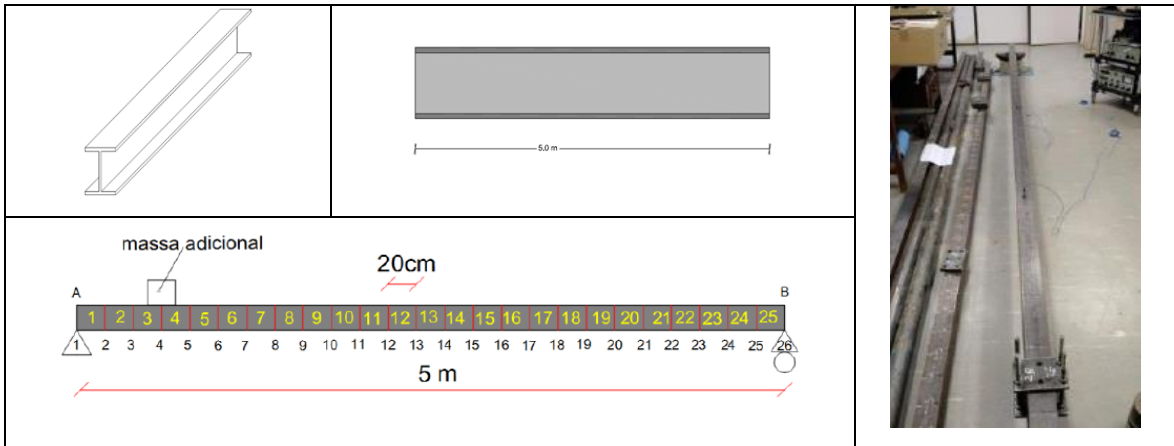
Viga Metálica Biapoiada Intacta (5 m): caso 11 (Palechor, 2018)
